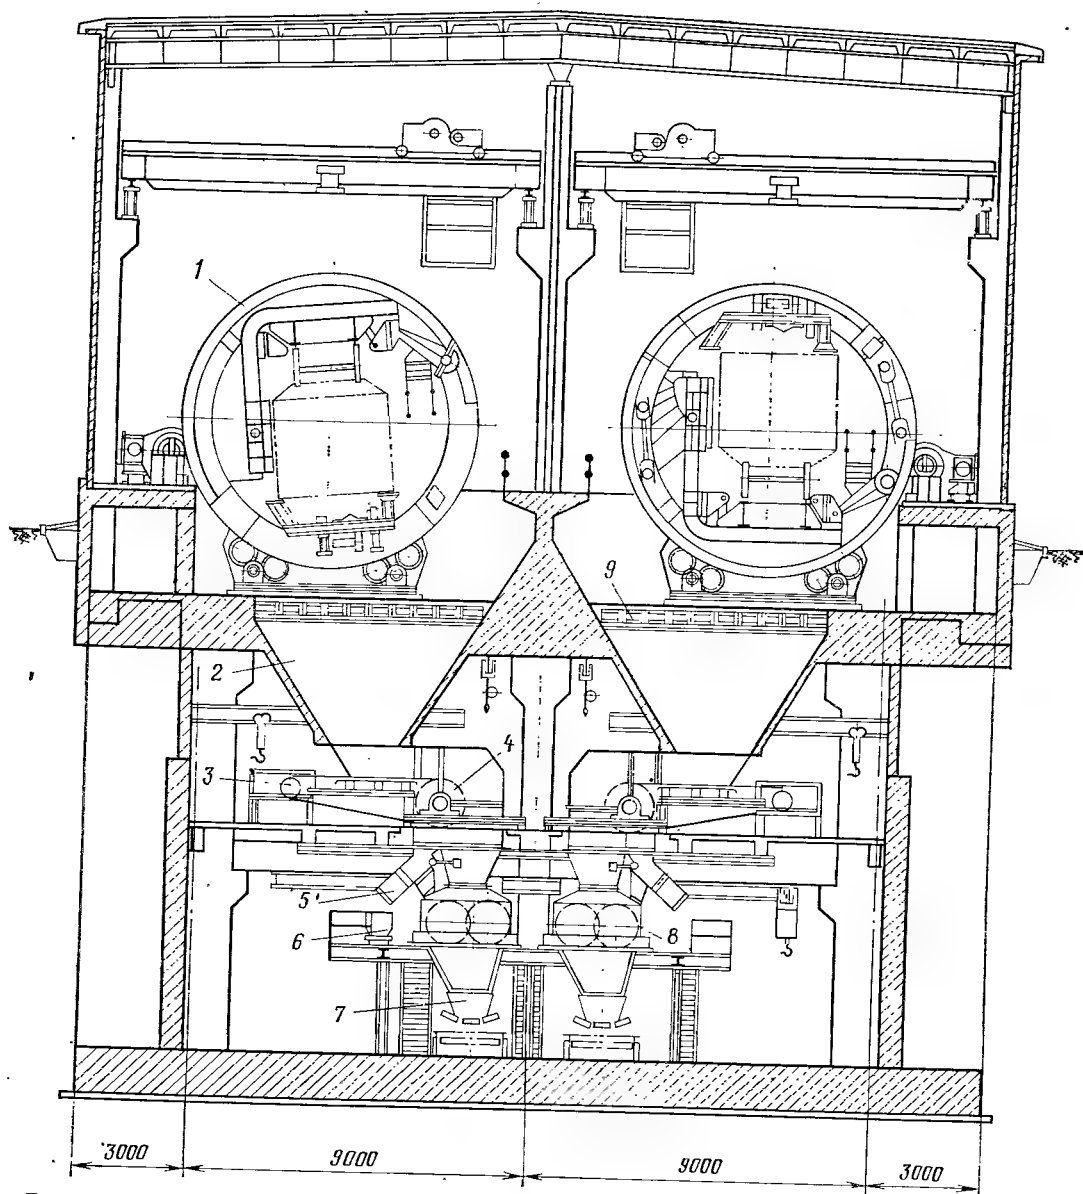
Разгрузочное устройство с двумя роторными вагоноопрокидывателями.
